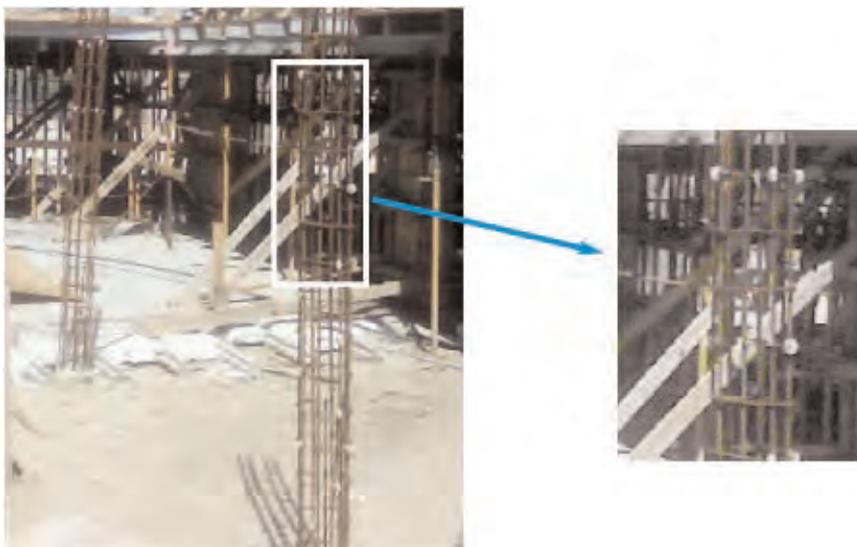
Separadores posicionados en armaduras de pilares
